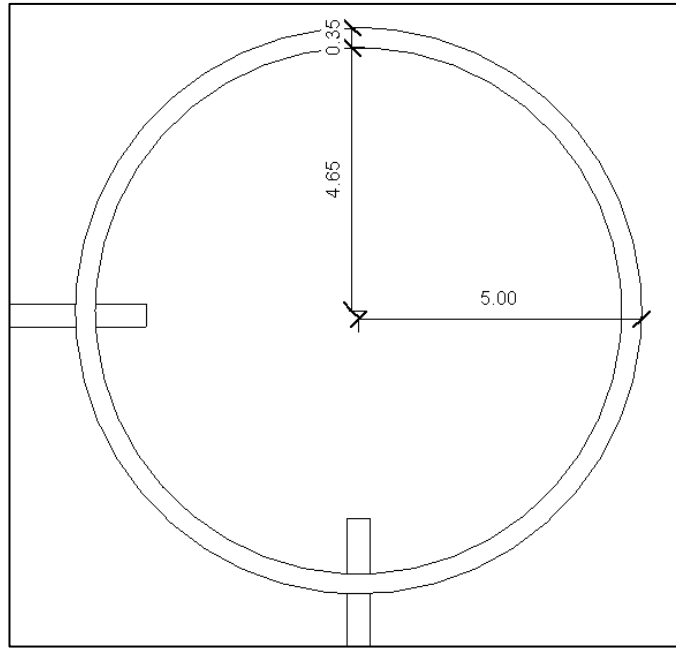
Vista en planta del tanque de aireación [Baque & Zavala, 2021]
